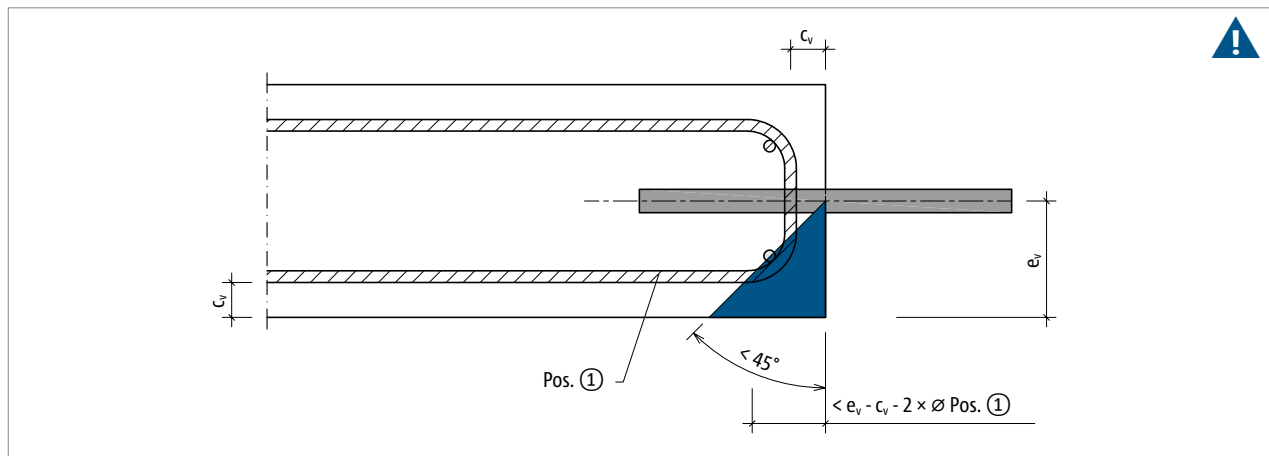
Schöck Stacon® type LD: Position of the longitudinal reinforcement in relation to the front face of the slab
